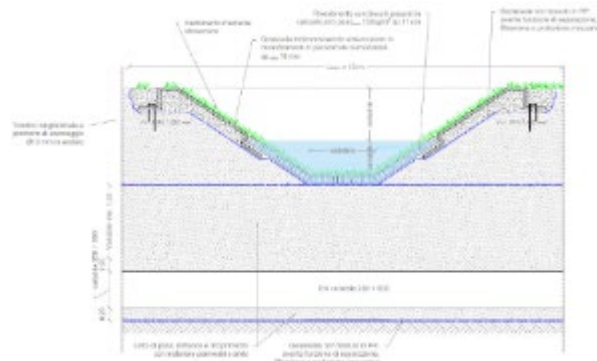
Attraversamento dei corsi d'acqua minori – sezione tipo
